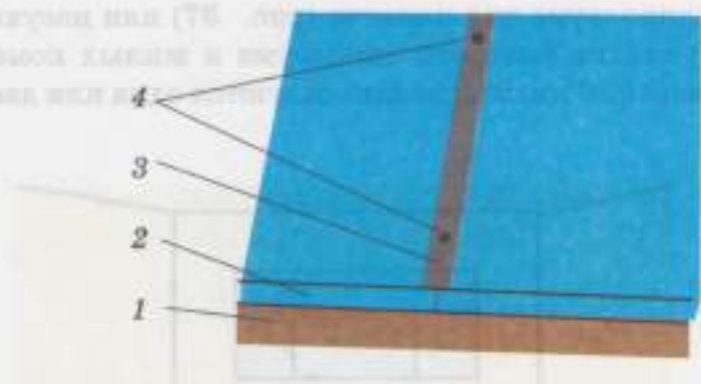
Закрепление кромок линолеума металлической рейкой:
